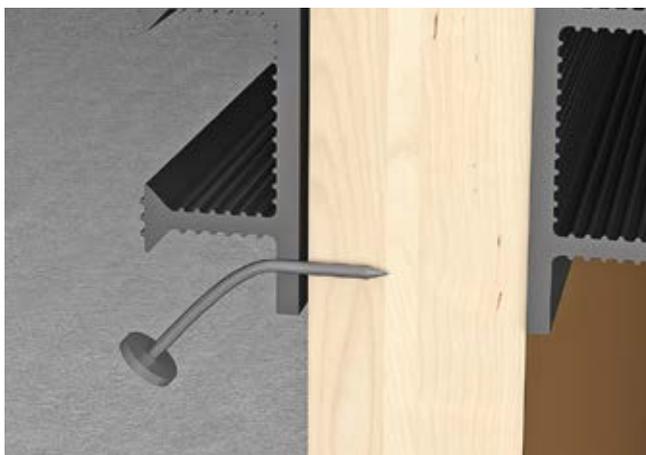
Крепление боковых и П-образных гидрошпонок к опалубке с помощью гвоздей
